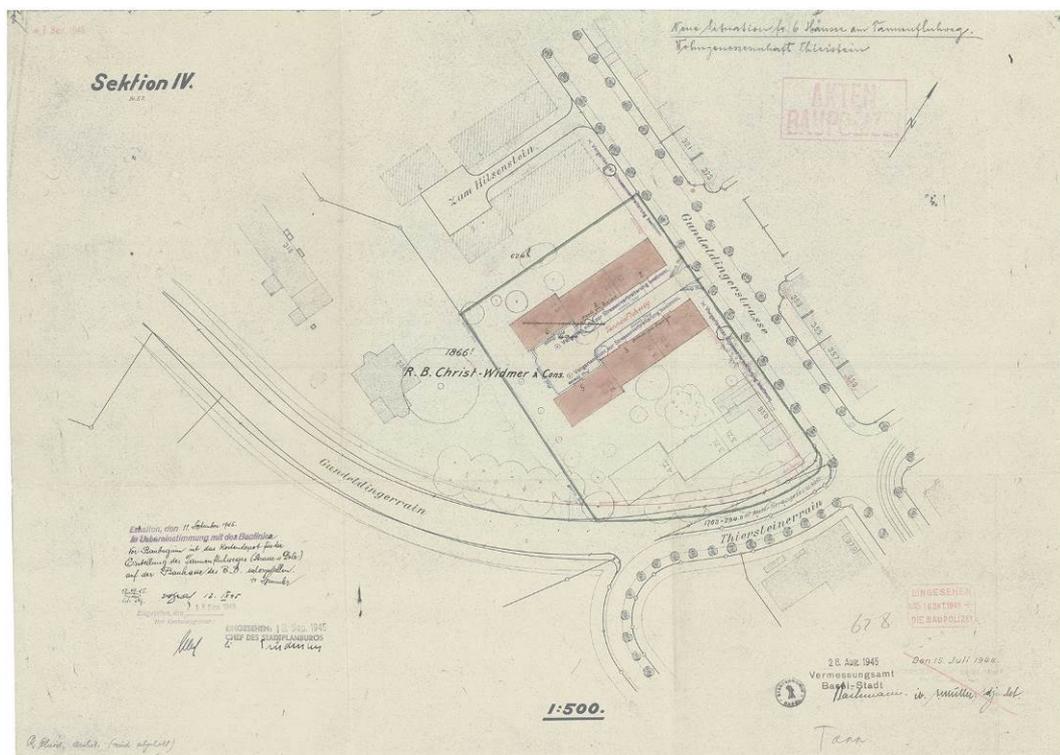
Baueingabeplan, Situation 1:500, Etappe 2, 1944. Architekturbüro Rudolf Christ, 15.6.1944 [Quelle: StaB]
